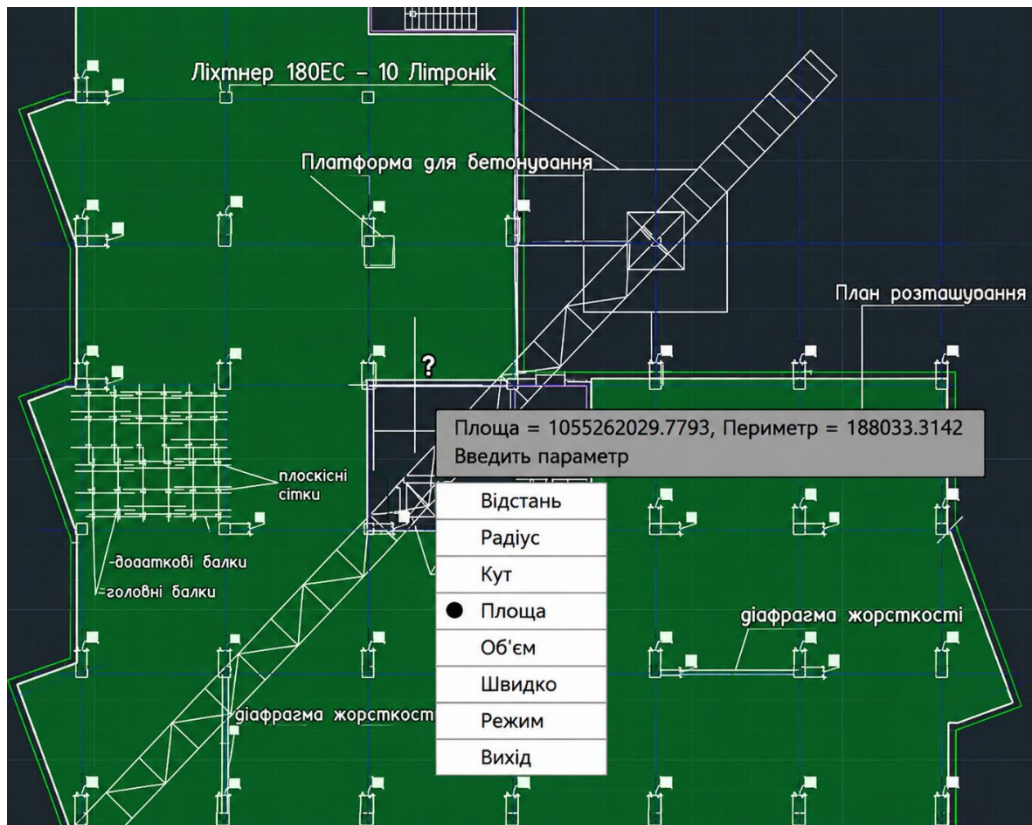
Визначення площі бетонування монолітного перекриття
